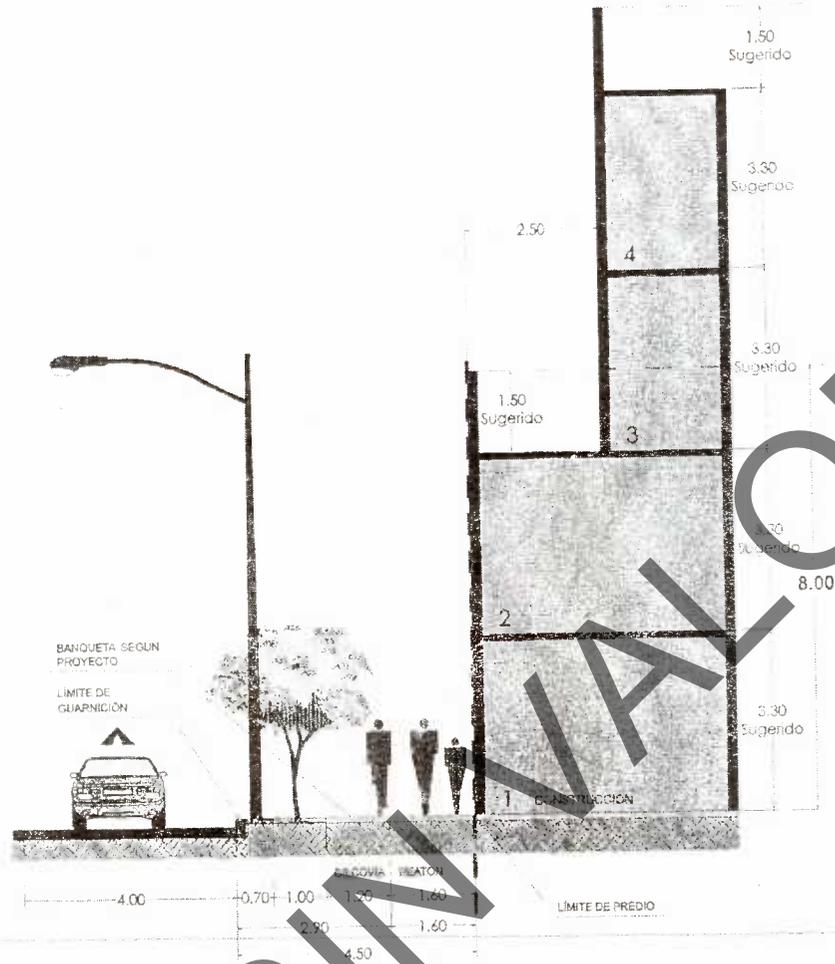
Detalle de Sección con rematamiento después de la altura de 8.00 m.
